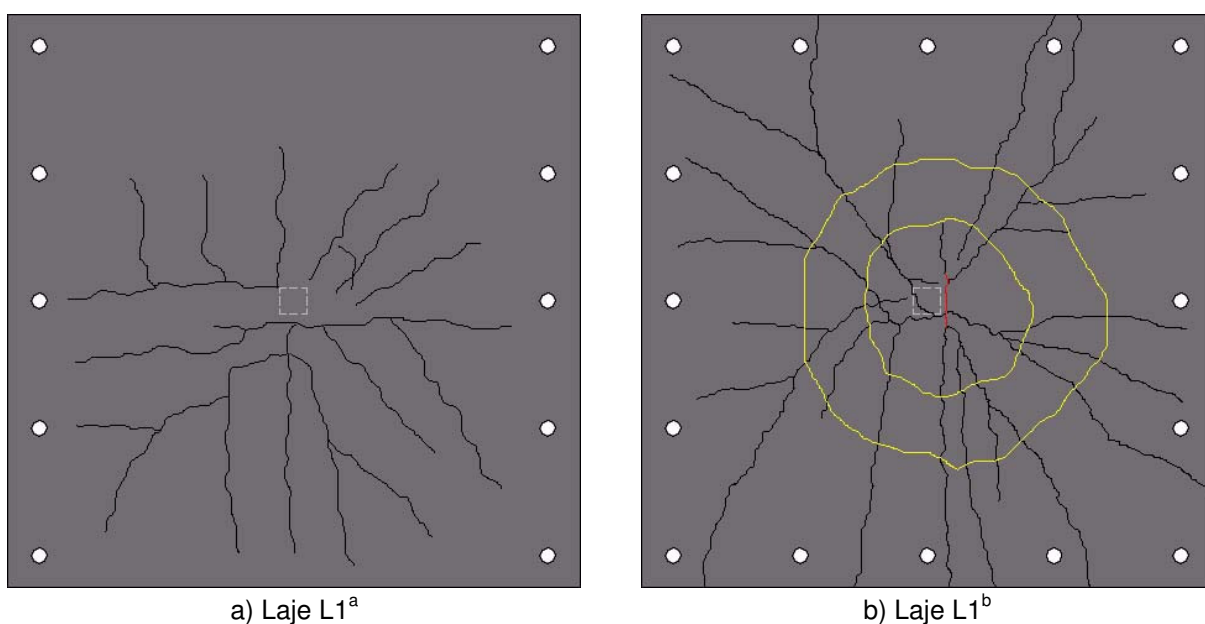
Mapa de fissuração das lajes do grupo 1
